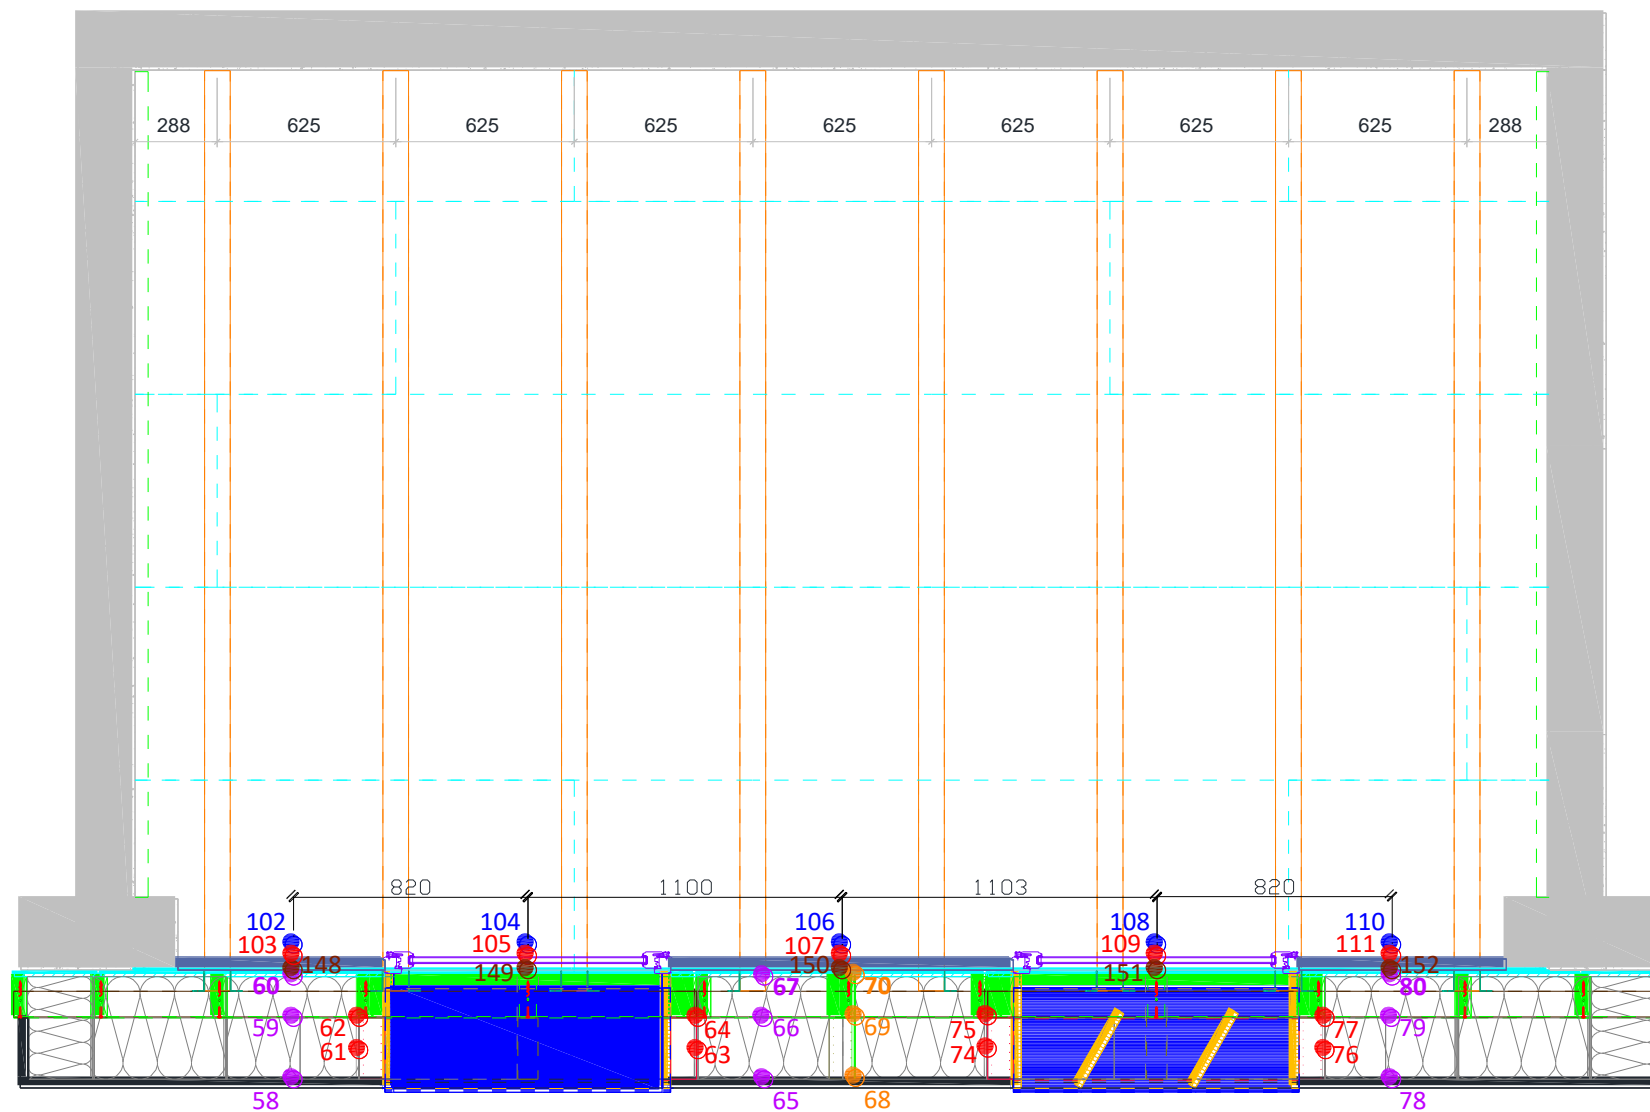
Instrumentation de l'élément de façade - Coupe I-I
